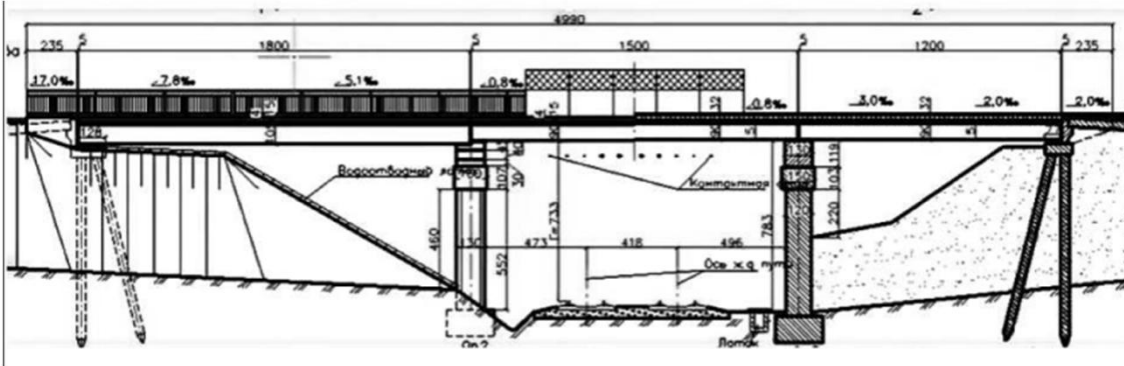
Поздовжній переріз прольотної будови шляхопроводу
